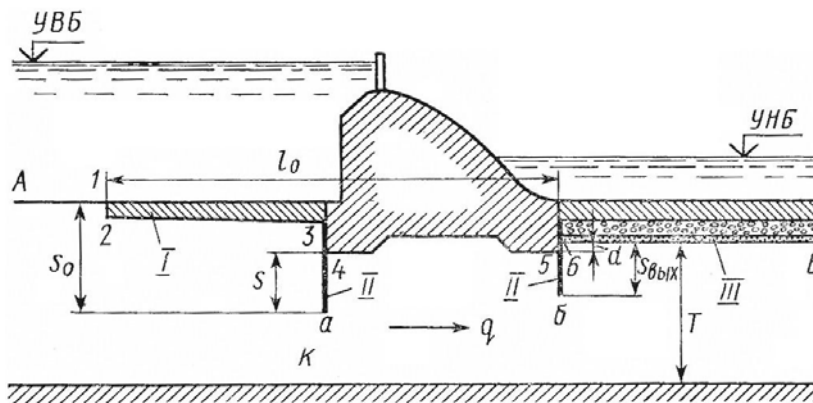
Бездренажный понур и фундамент плотины (схема 1):
